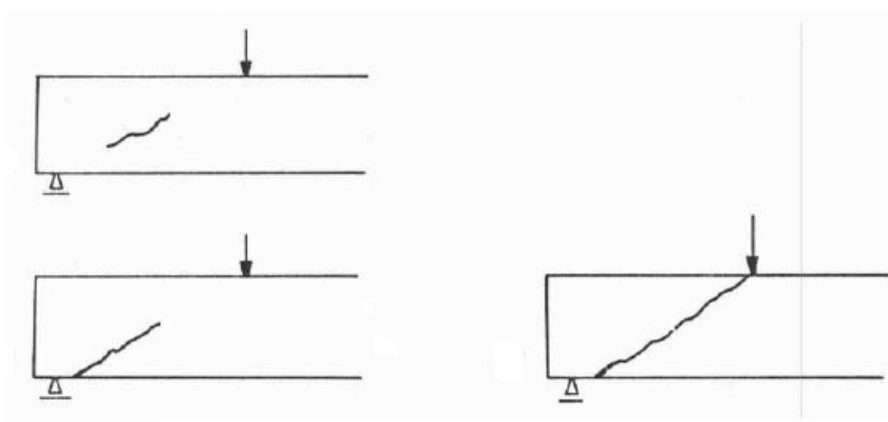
Fissuras em vigas, causadas por cisalhamento.
